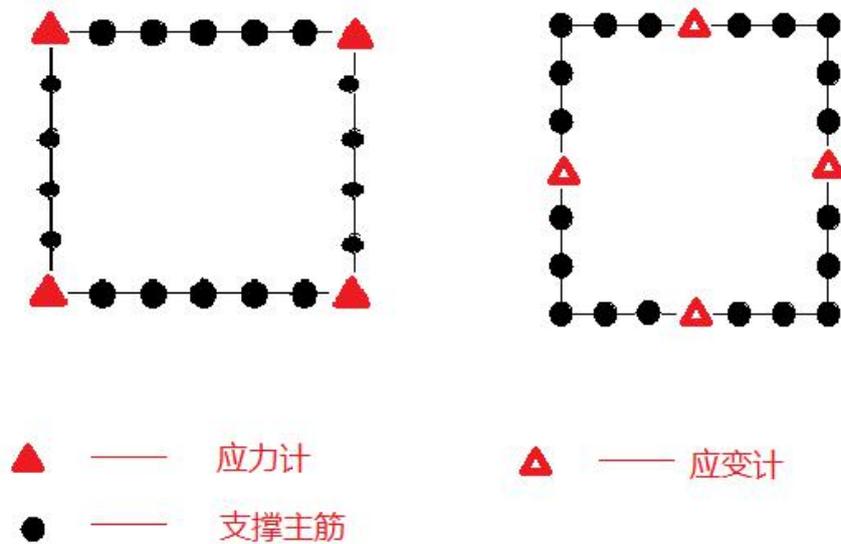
钢筋混凝土支撑轴力检测应力计（应变计）布置示意图
